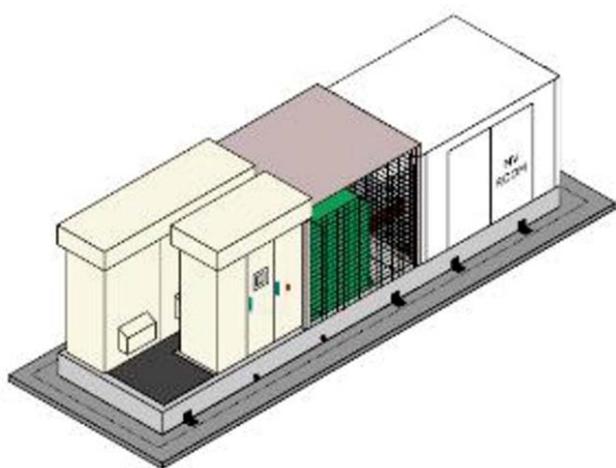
Pianta e prospetto del gruppo di conversione e trasformazione.
